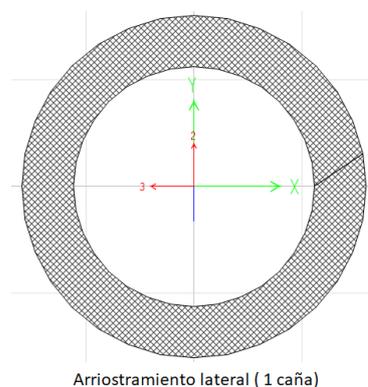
Sección transversal de arriostramiento longitudinal. Fuente: Propia
